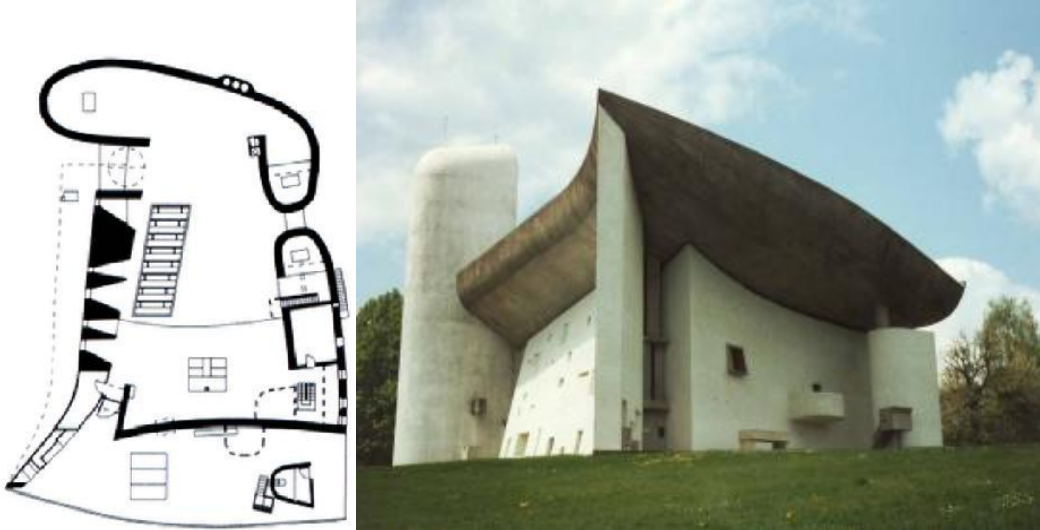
Le Corbusier. Notre Dame du Haut (Ronchamp). Alzado e planta
